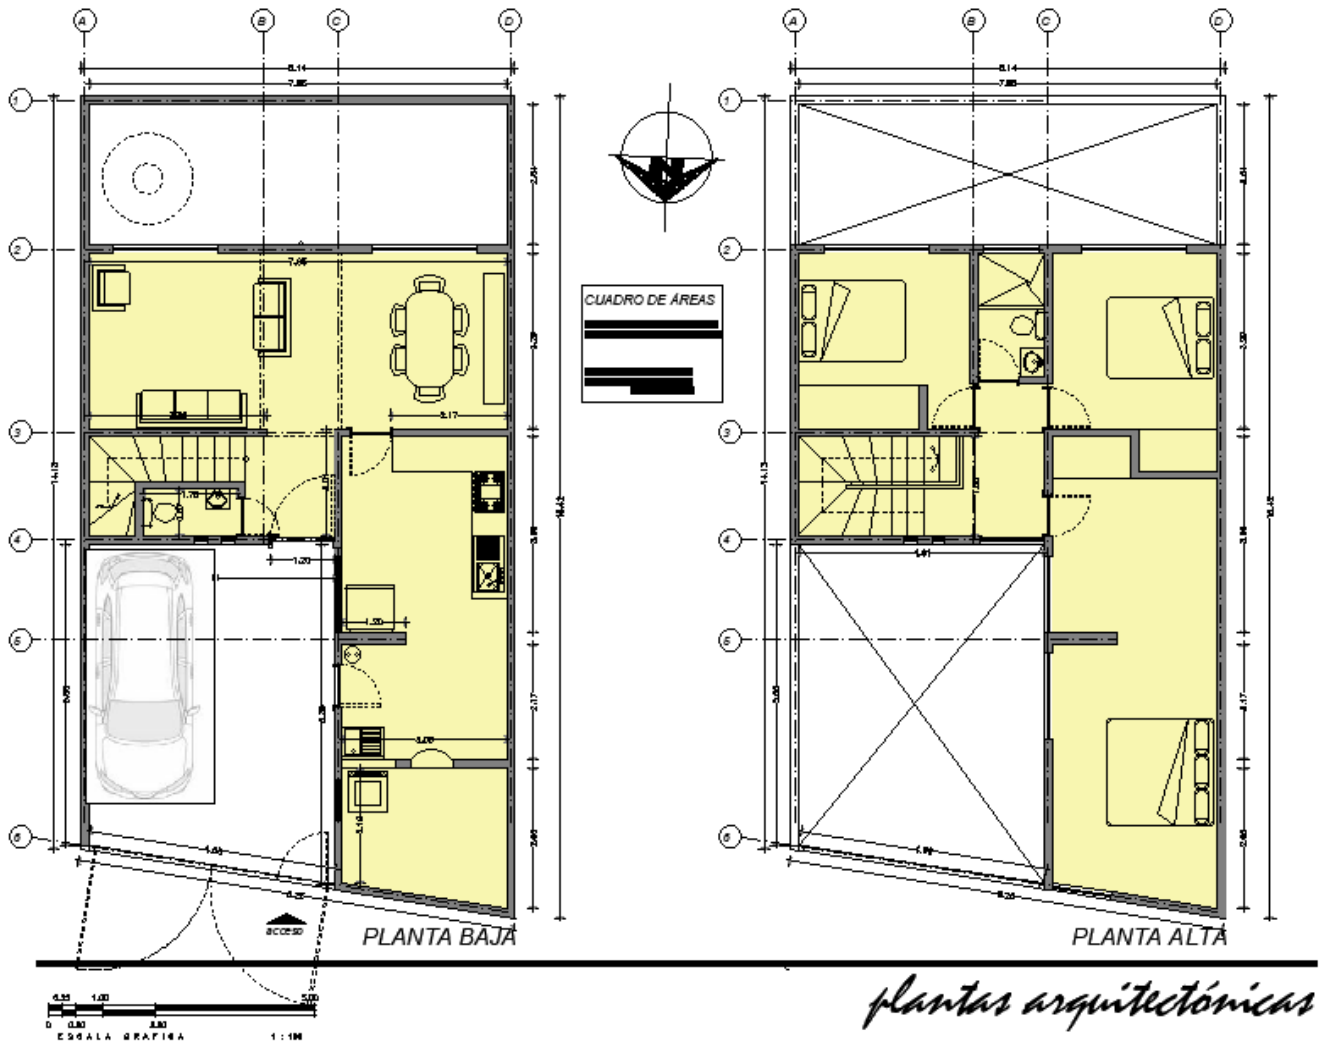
Planos de levantamiento del inmueble antes de la intervención. Autoría propia
